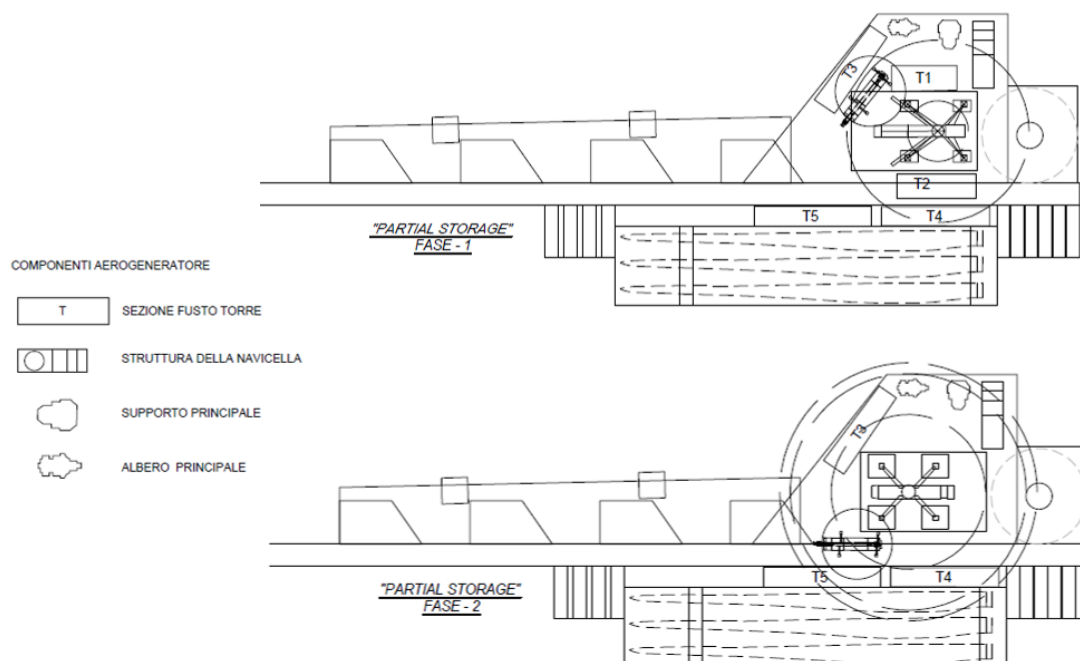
Tipologico piazzola in fase di cantiere con sistema di montaggio “Partial storage”
